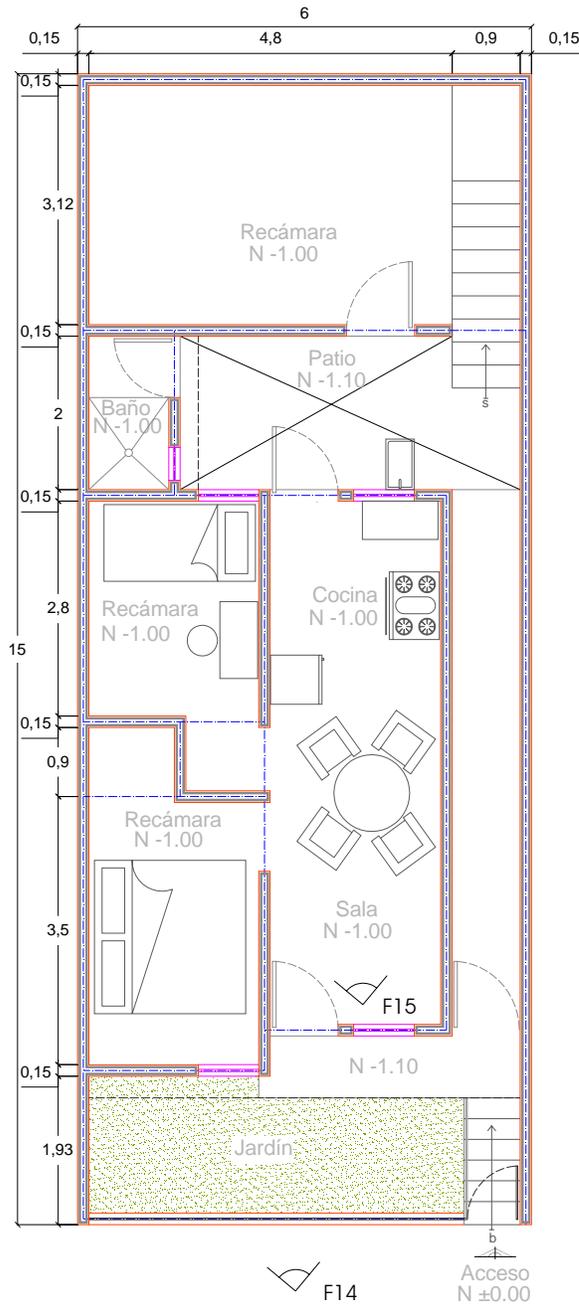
Estado actual de la planta arquitectónica en una vivienda tipo de la colonia Convide
